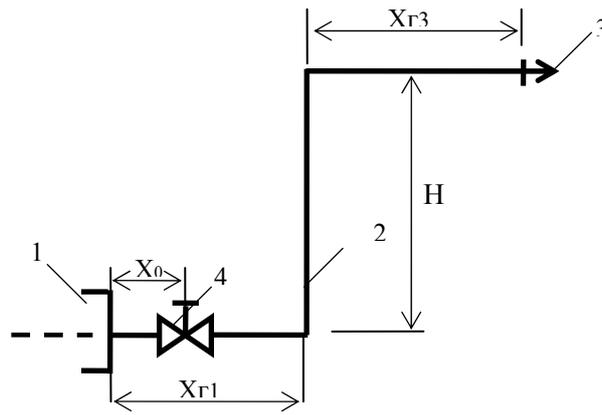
Типовая схема подачи воды на пожаротушение от пожарного крана:
